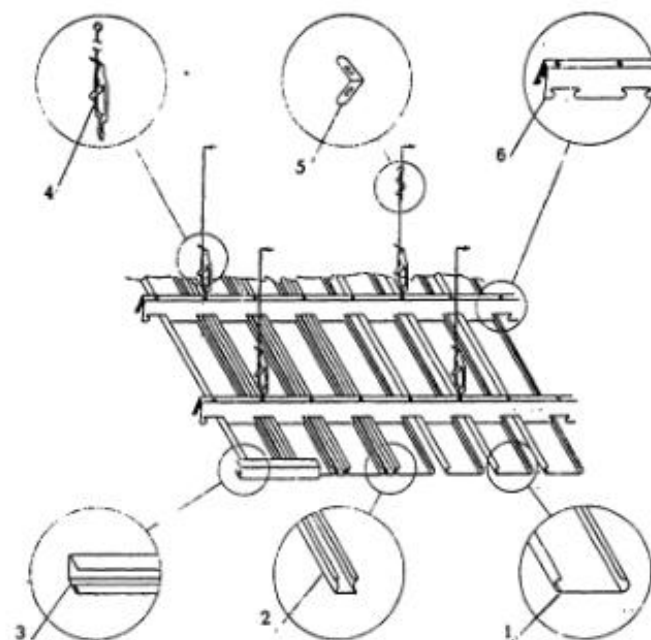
Реечные металлические потолки: 1 - алюминиевая рейка; 2 - межреечный профиль; 3 - торцевой элемент; 4 - спица с регулировочной пружиной; 5 - соединительная скоба; 6 - несущий профиль (стрингер)
